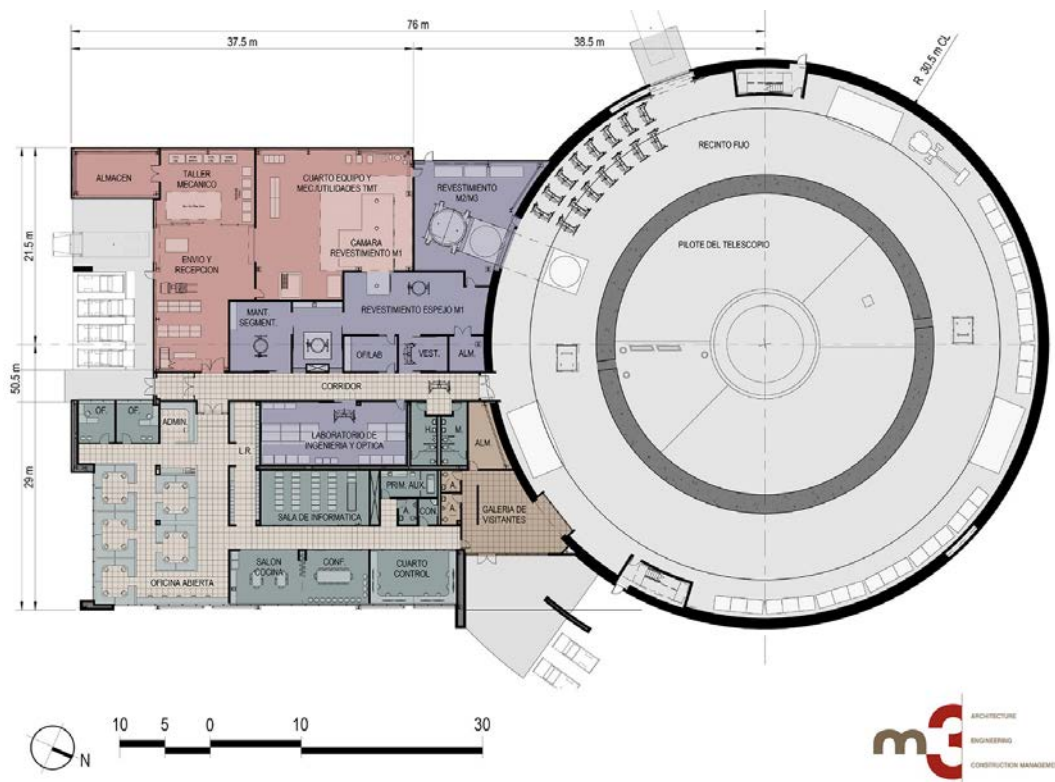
Instalación Auxiliar TMT – planta conceptual
